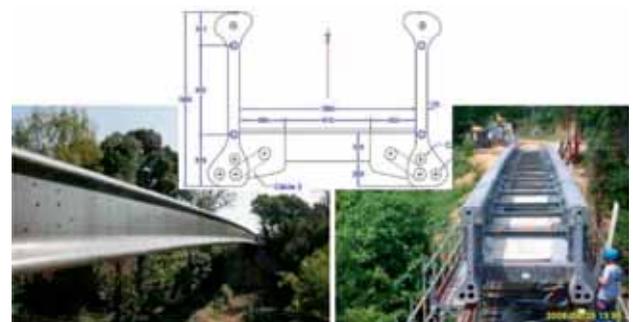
Пешеходный мост Passerelles des Anges, Франция, 2008 г. Однопролетный 70-метровый балочный мост из предварительно напряженного СПФБ. Строительная высота балок постоянная – 1,8 м (1/38 длины пролета). Обычное стержневое армирование отсутствует. Пролетное строение снабжено гасителями колебаний. Применена универсальная опалубочная форма, которая использовалась и на других сооружениях.
